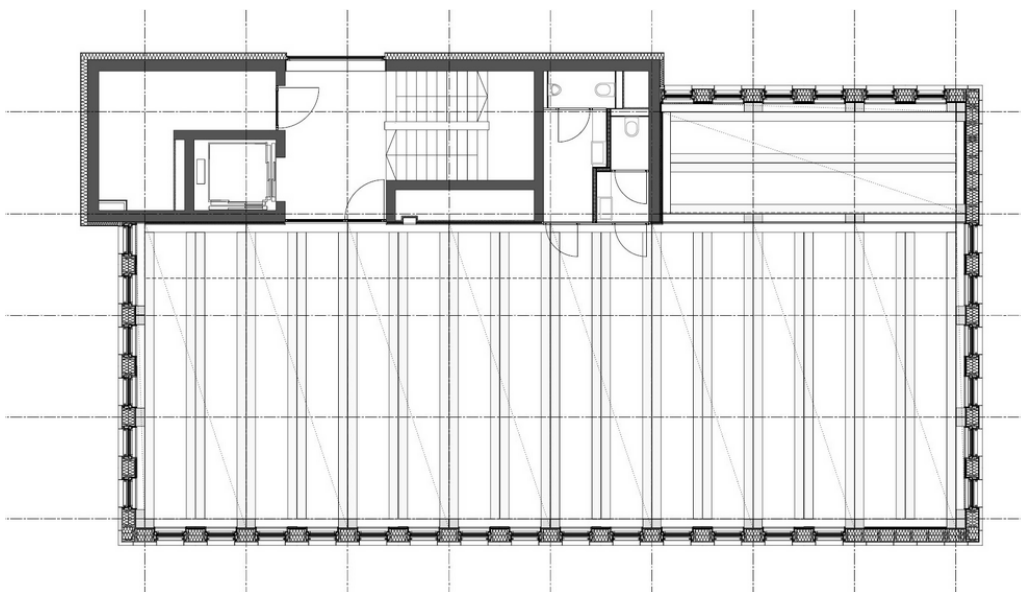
Grundriss des LCT ONE → Viertelgrundriss des Forschungsprojektes
